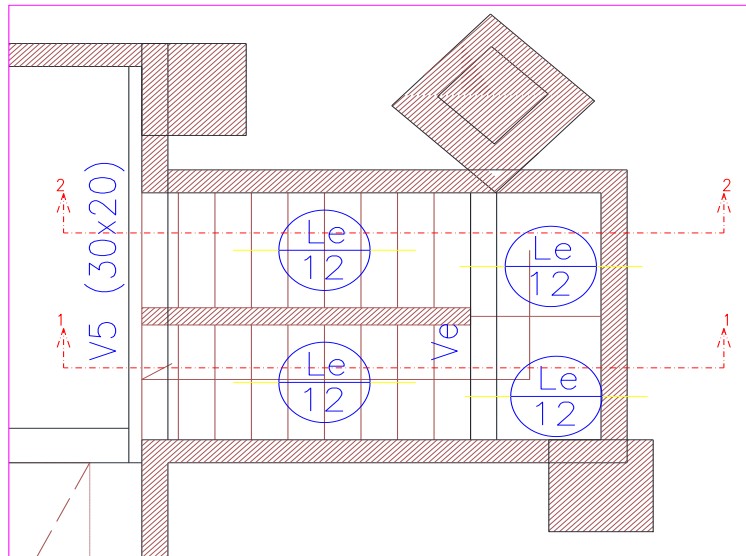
Planta de la estructura de la escalera de hormigón armado.
